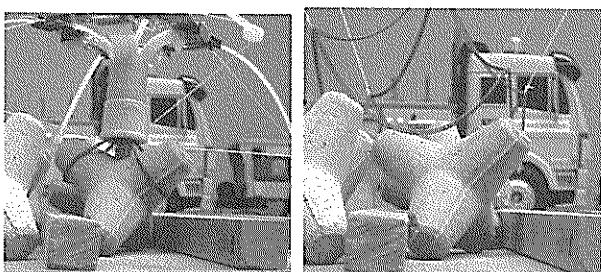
凹部にブロック着地 写真-2 ワイヤーを緩め解放
